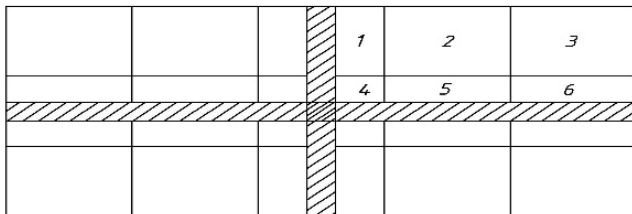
Схема замены плиты на пересекающиеся балки
